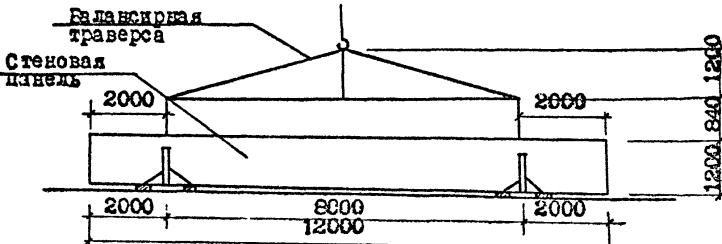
Строповка стеновой панели при разгрузке и монтаже.
